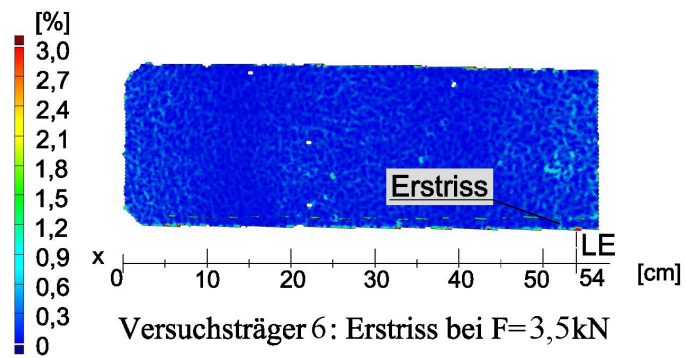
Versuchsträger 6- Lage Erstriss
